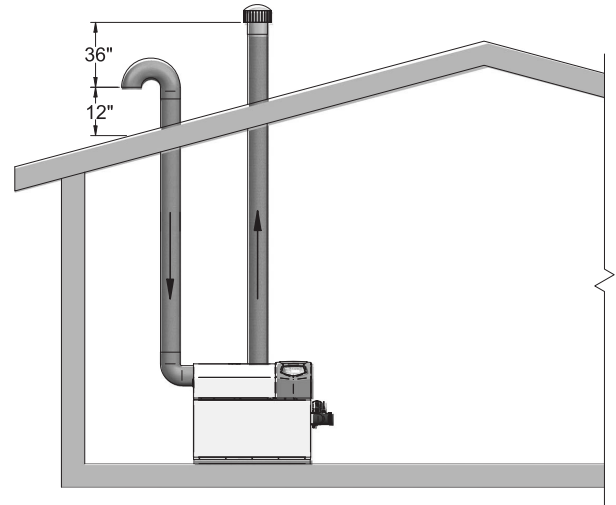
Installation DirectAir verticale avec air de combustion par le toit
